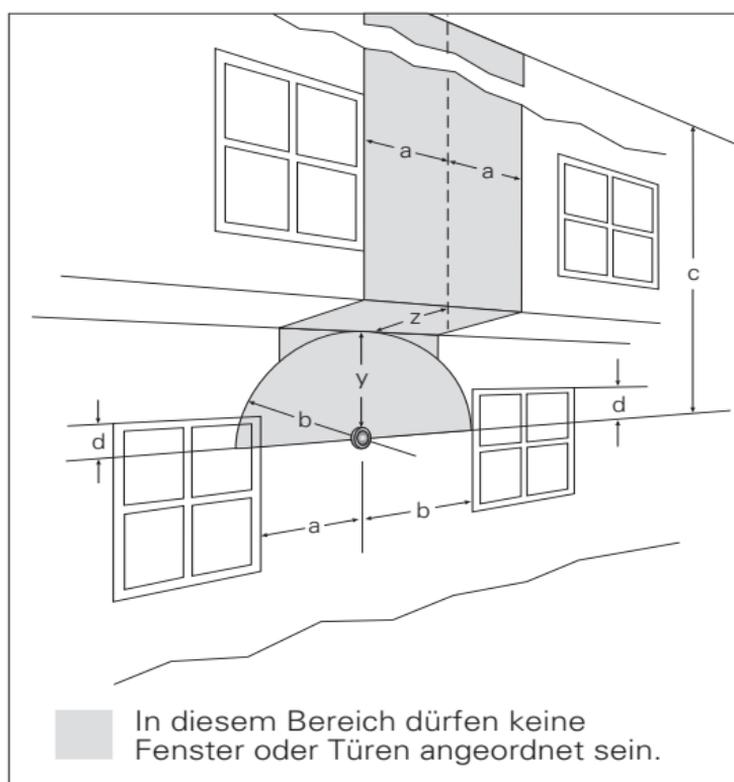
Mindestabstände einer einzelnen Abgasmündung zu Fenstern, die geöffnet werden können, oder zu Fassadentüren bei Fassaden mit Vorsprung
